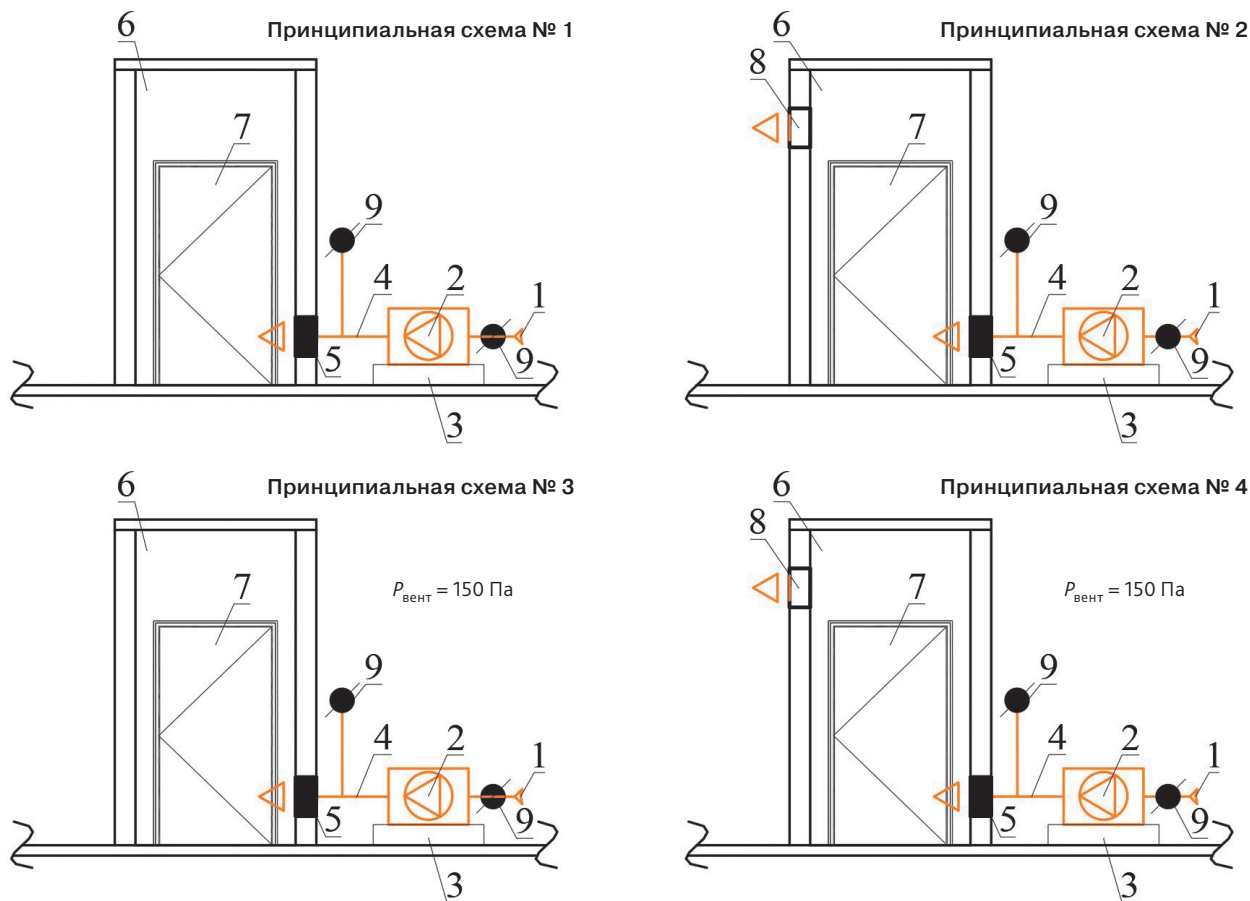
Принципиальные схемы установок № 1, 2, 3, 4 (вид спереди): 1 – воздухозабор; 2 – осевой вентилятор ПД; 3 – стойка вентилятора; 4 – воздуховод; 5 – нормально закрытый клапан противопожарный стеновой; 6 – тамбур-шлюз; 7 – дверь в ТШ с доводчиком; 8 – КИД; 9 – регулирующий клапан (РК) расхода воздуха
